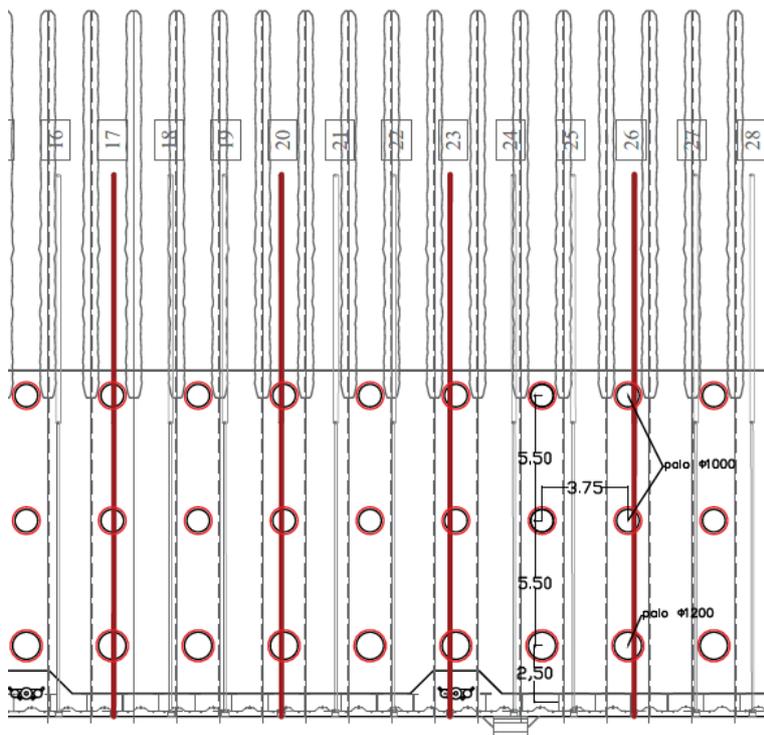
Bunge Sud – Progetto Esecutivo Soluzione – Planimetria intervento
